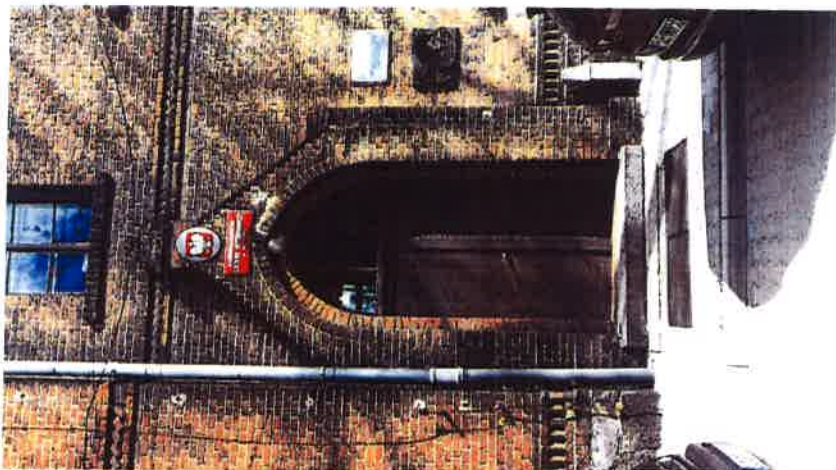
zdjęcie z zewnątrz głównych drzwi wejściowych – elewacja zachodnia
